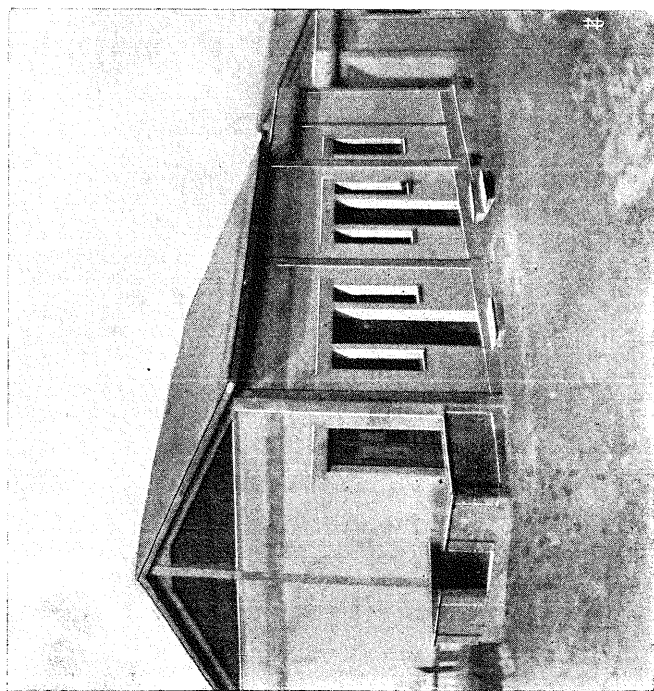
Casa con ossatura di cemento armato a Favelloni Piemonte.
